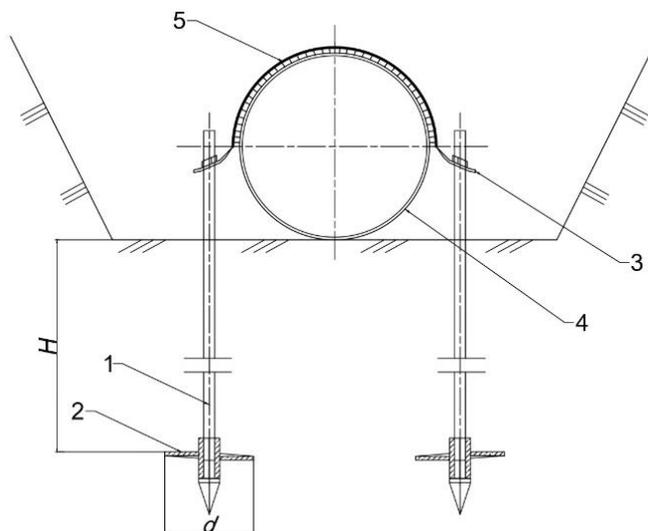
Схема конструкции стержневого анкерного устройства: 1 – тяга анкерная; 2 – винт анкера; 3 – силовой пояс; 4 – трубопровод; 5 – прокладка [1]
